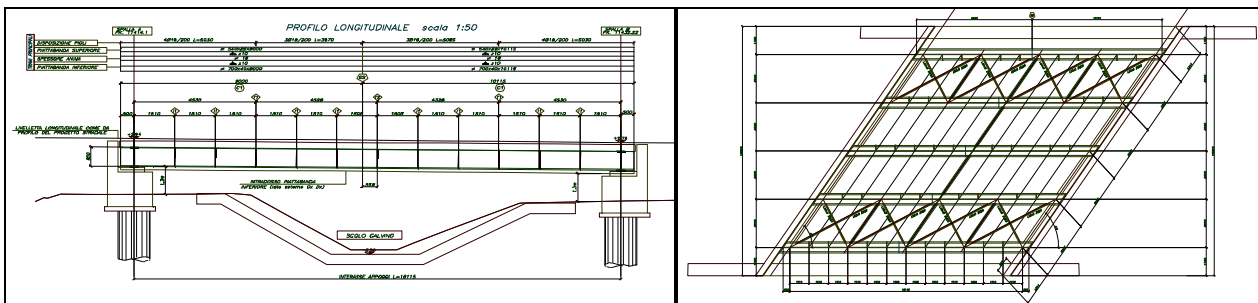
Profilo longitudinale e Planimetria dell'impalcato Ponte Scolo Galvino
